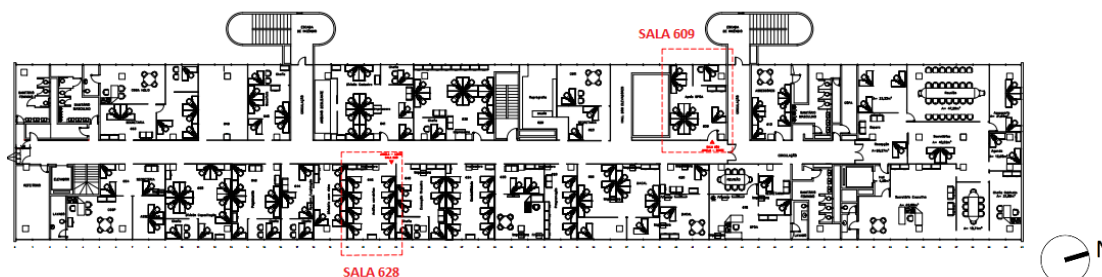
Planta do 6º pavimento com ambientes monitorados em destaque. (Pós-*retrofit*)
